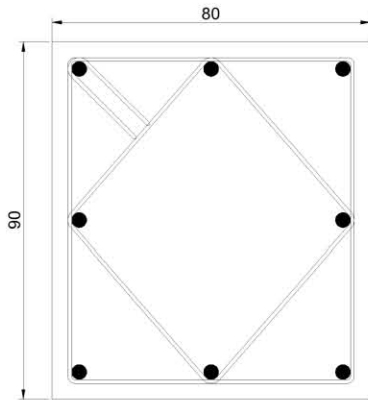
Detallado de acero longitudinal y estribos en columnas (continuación)
